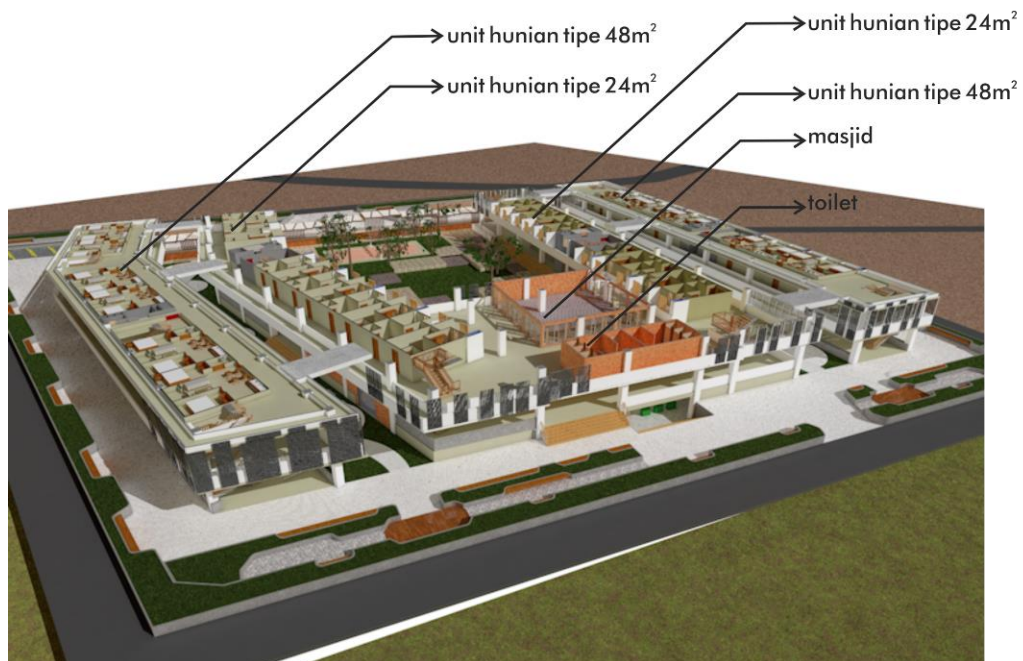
Konsep Tata Ruang Bangunan Lantai dasar
